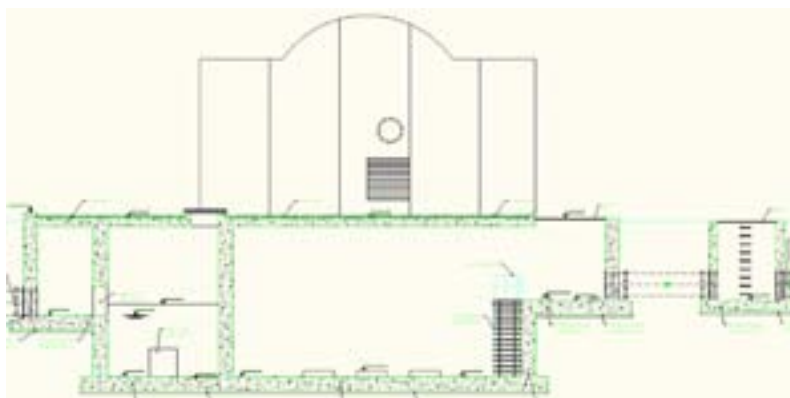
Sección longitudinal edificio EBAR Vial Peñíscola-Benicarló.
